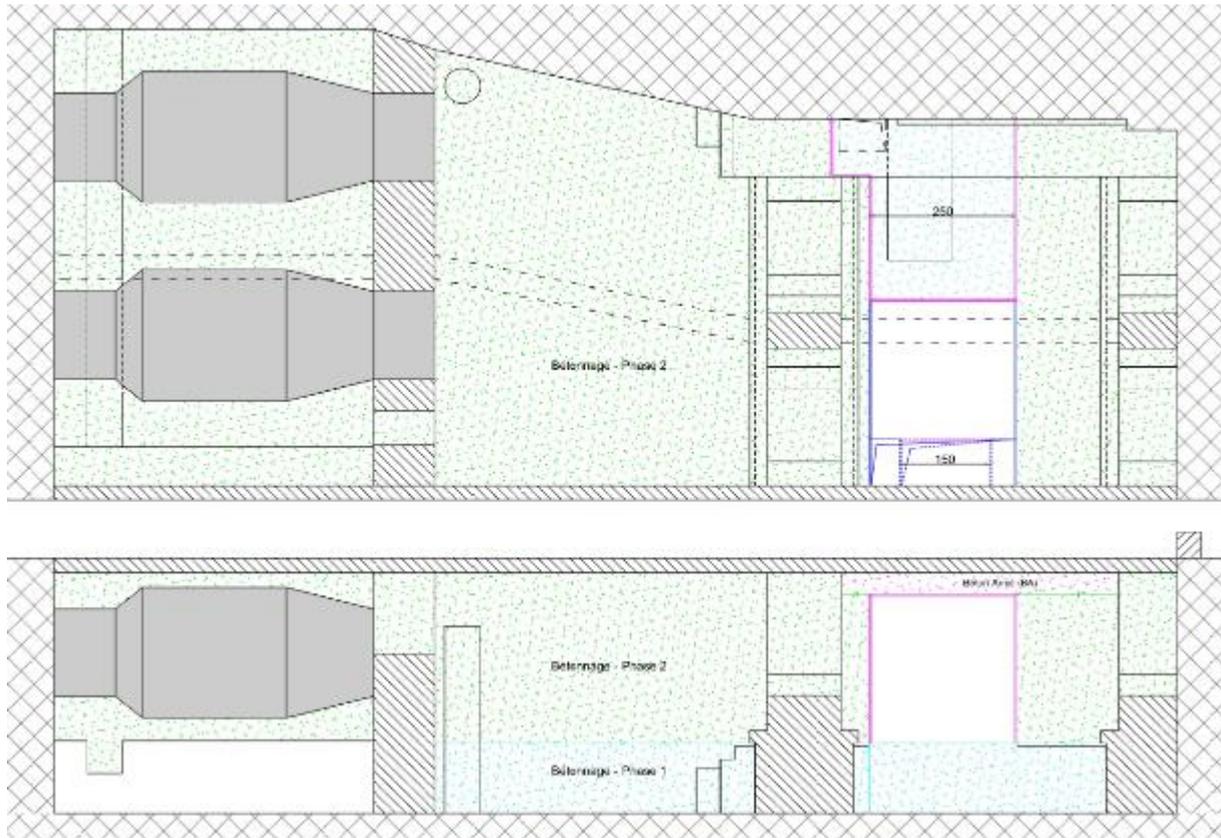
Vue en plan et en coupe longitudinale de l'aménagement
